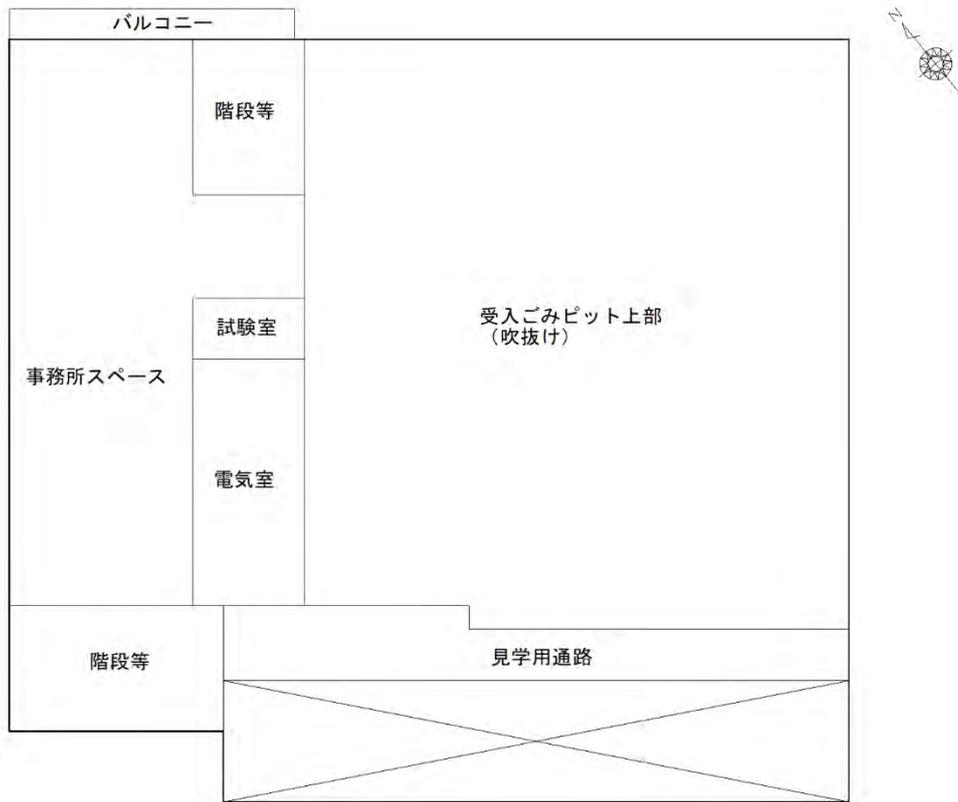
(5) 廃棄物受入棟平面図 (4 階)
